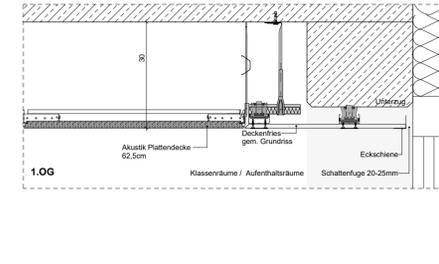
Decke 1 - Querschnitt Wandanschluss
